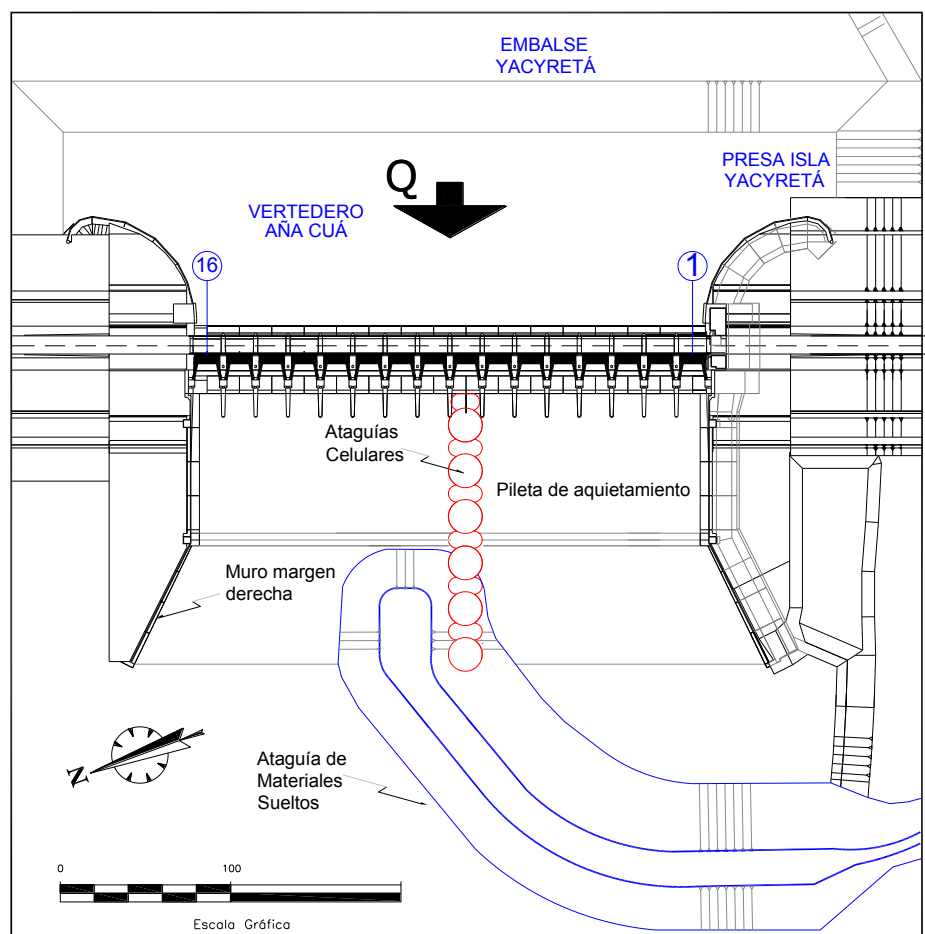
Planta del vertedero sobre el Brazo Aña Cuá y recinto de construcción.
